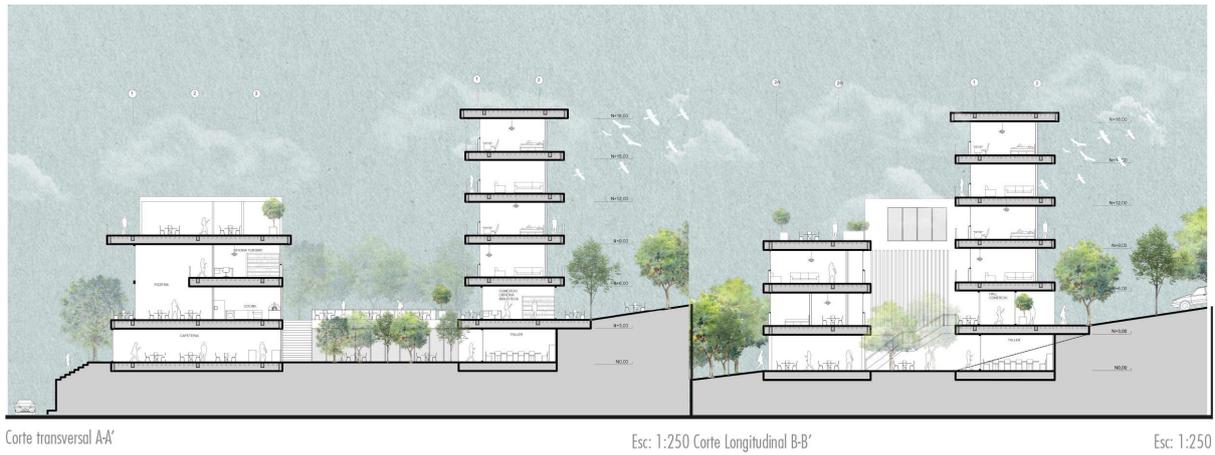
Cortes transversales A-A' Y B-B' proyecto centro cooperativo. Elaboración propia
